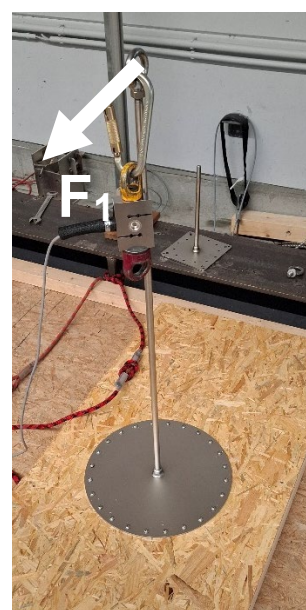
Prüfaufbau 4, Anschlagereinrichtung,
